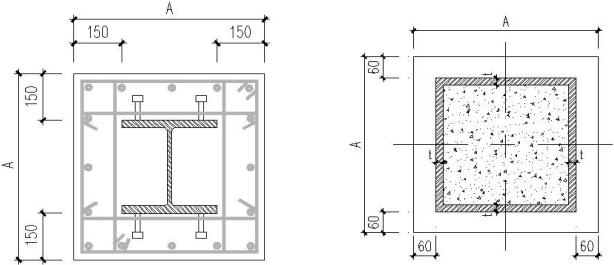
预制劲性柱标准截面示意及相对应的加劲钢管标准截面示意
